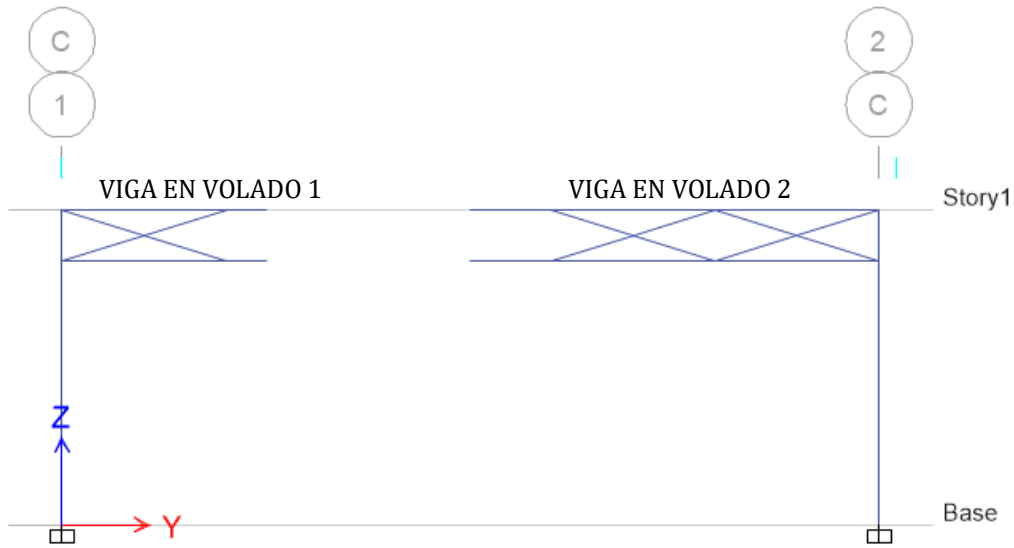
Eliminación de elementos de la brida superior y diagonales que llegaron a la falla.
